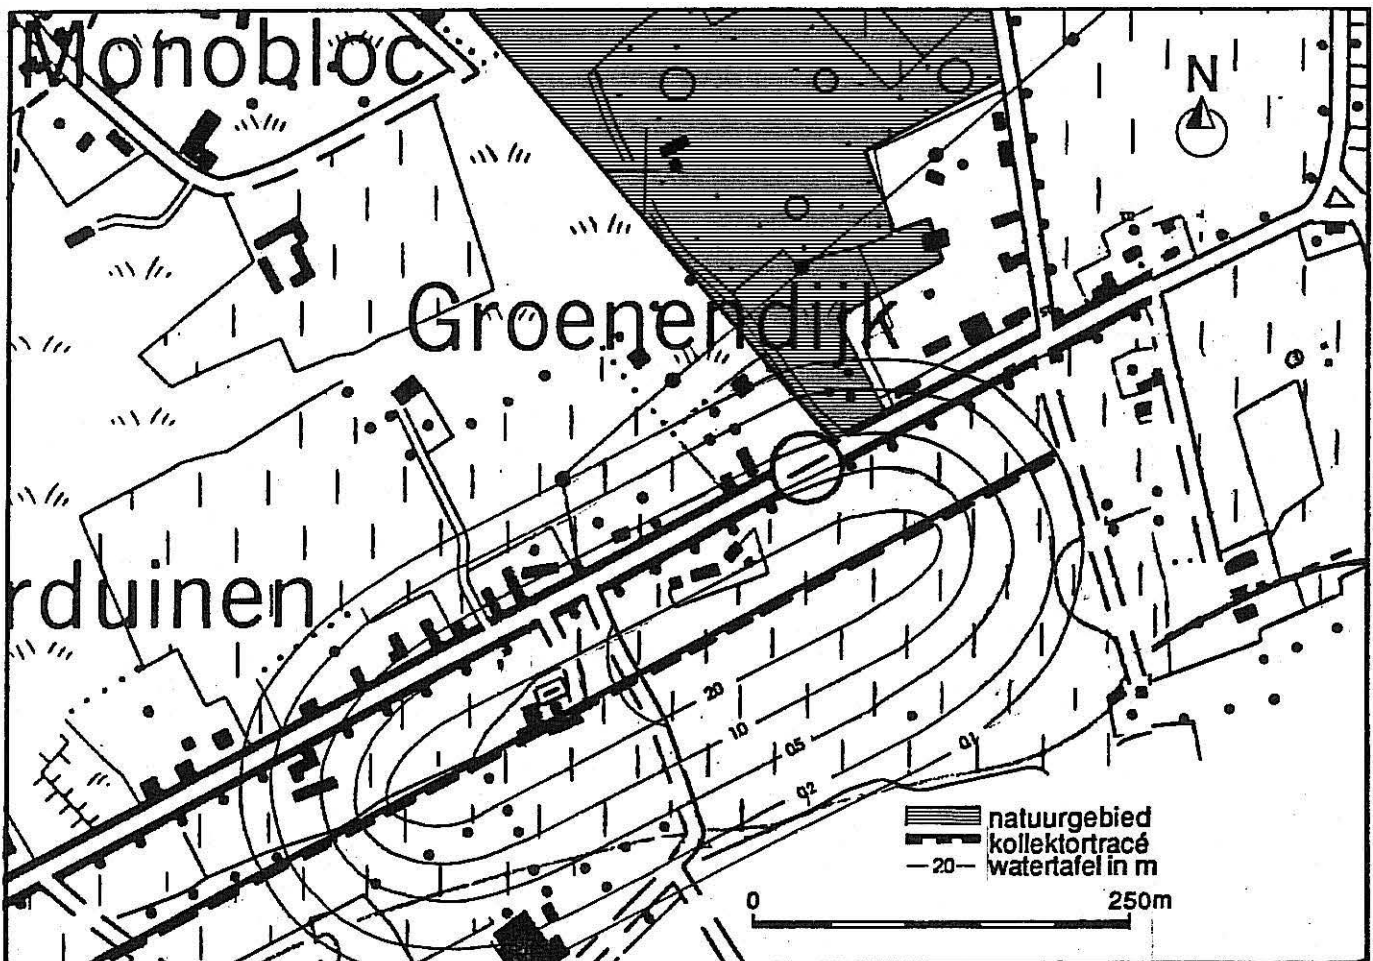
Ligging van het kollektortracé ten opzichte van het Gewestplan.
